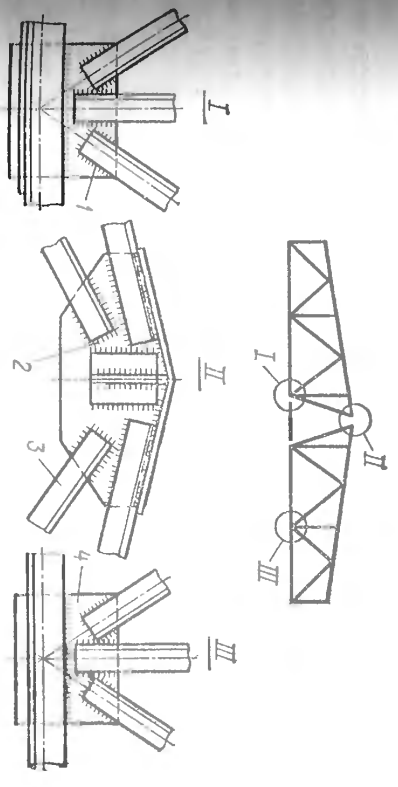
Узлы (I... III) стропильной фермы:
